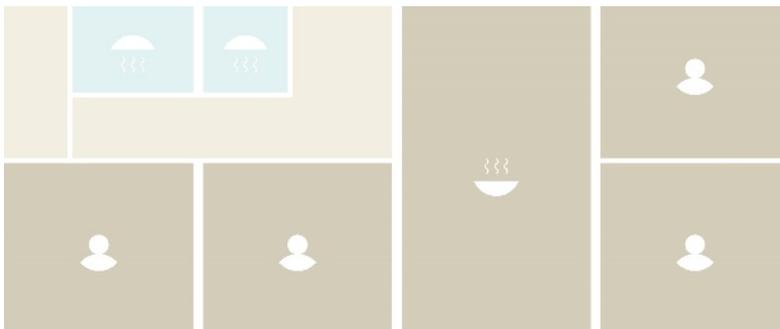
Schema Grundriss 4-Zimmer inkl. Wohnküche (Architekt Schweizer)
